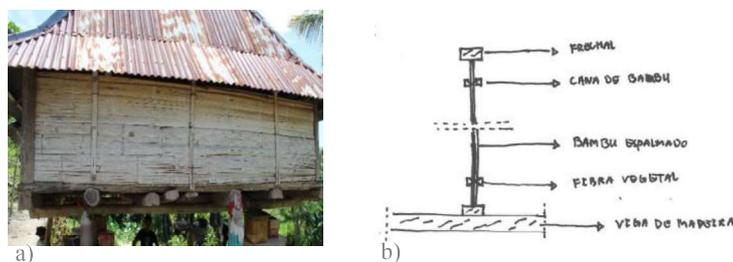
33. Tipos de parede de bambu. a) Parede de bambu espalmado colocado em horizontal b) Desenho em corte da parede.
